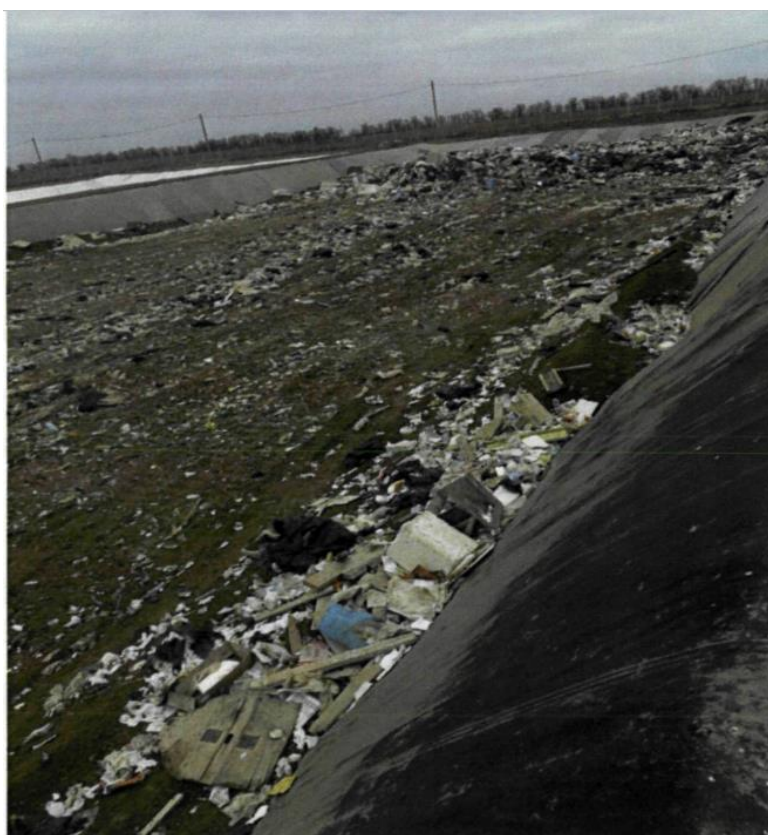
Загальний вигляд робочої карти після формування проміжного ізоляційного шару
